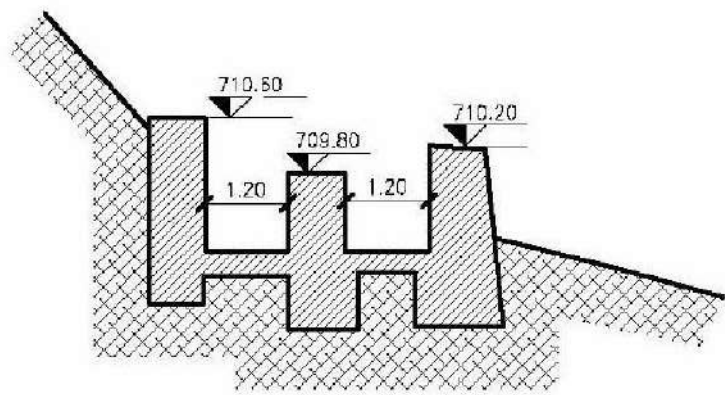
DETTAGLIO PRESA EUGIO BASSA
